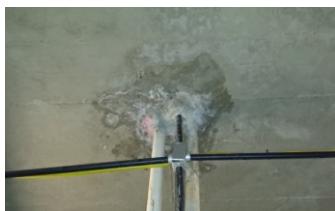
Laje no teto do poço do elevador, em janeiro de 2014.
